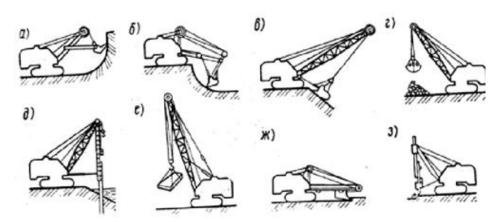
Примеры схем сменного рабочего оборудования универсального строительного экскаватора: а – прямая лопата, б – обратная лопата, в – драглайн, г – грейфер, д – копер для забивки свай, е – кран, ж – струг, з – разрыхлитель грунта
